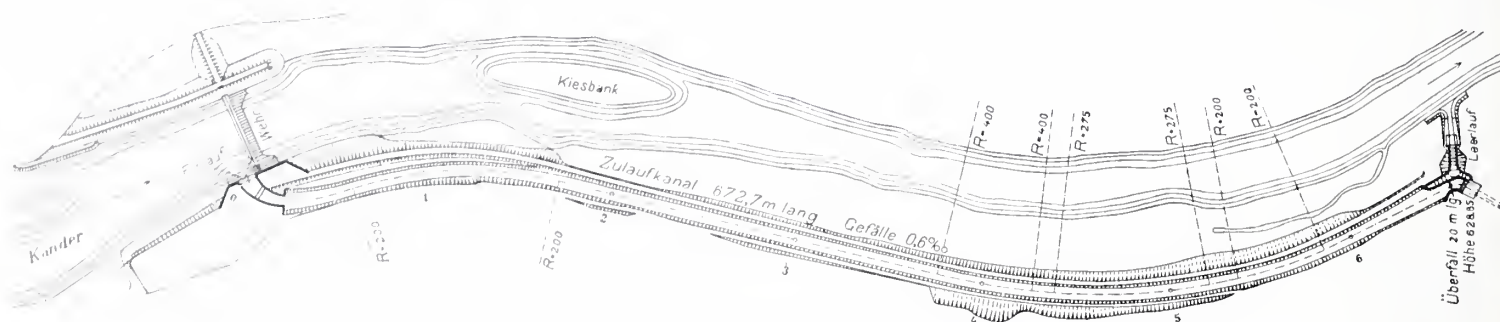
Lageplan des Zulaufkanals mit Wehr, Ueberfall und Stolleneinlauf. — Masstab 1 : 4000.
